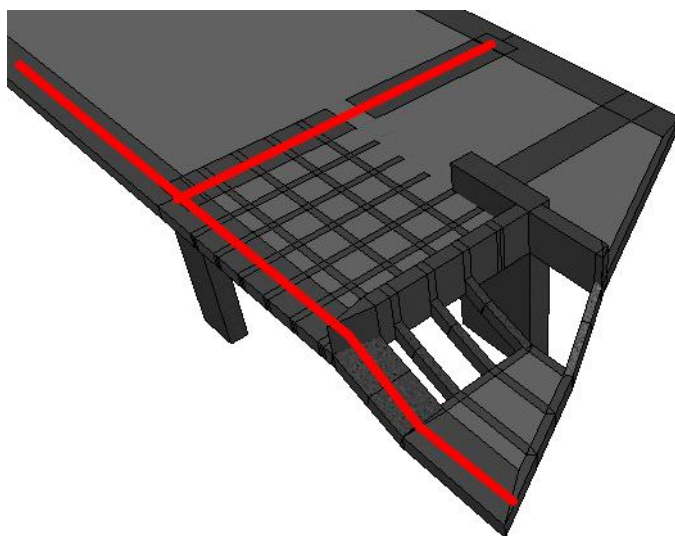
Perspectiva do modelo estrutural de análise preliminar destacando as vigas faixas.
